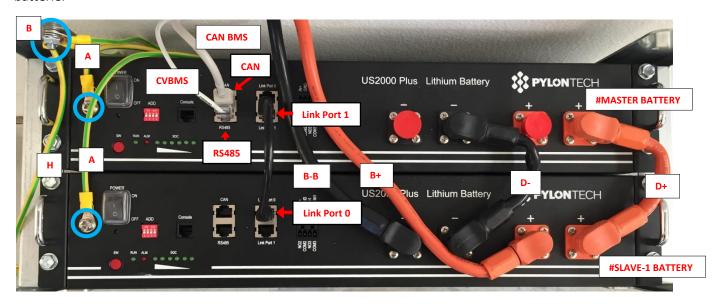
Collegamenti necessari quando si installa il WALL-BOX-Bx BASE
